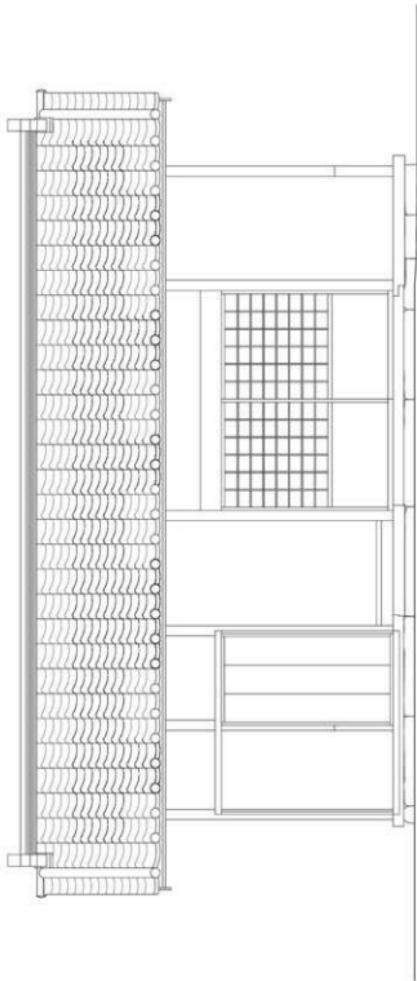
楚屋 墓工 北立面图 5=1/50
